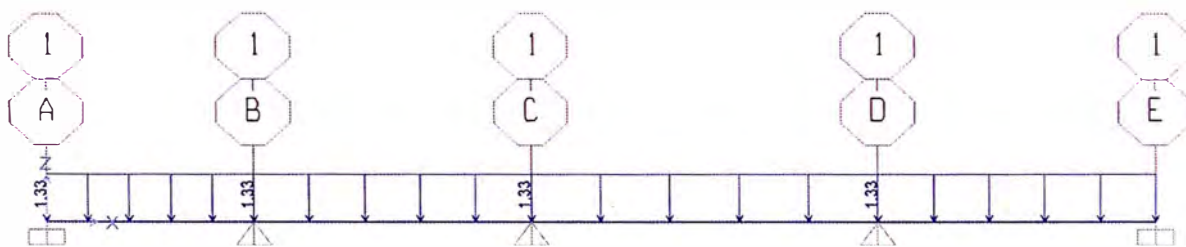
Carga muerta en la viga. Fuente: SAP2000.
